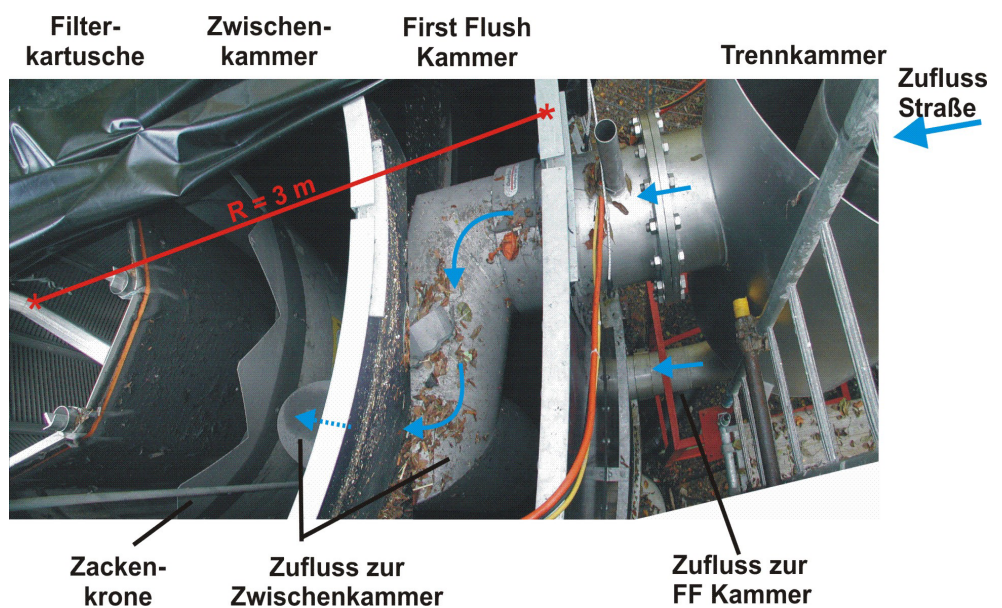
Pilotanlage Stadttangente Bern Nord/CH, Draufsicht-Ausschnitt
